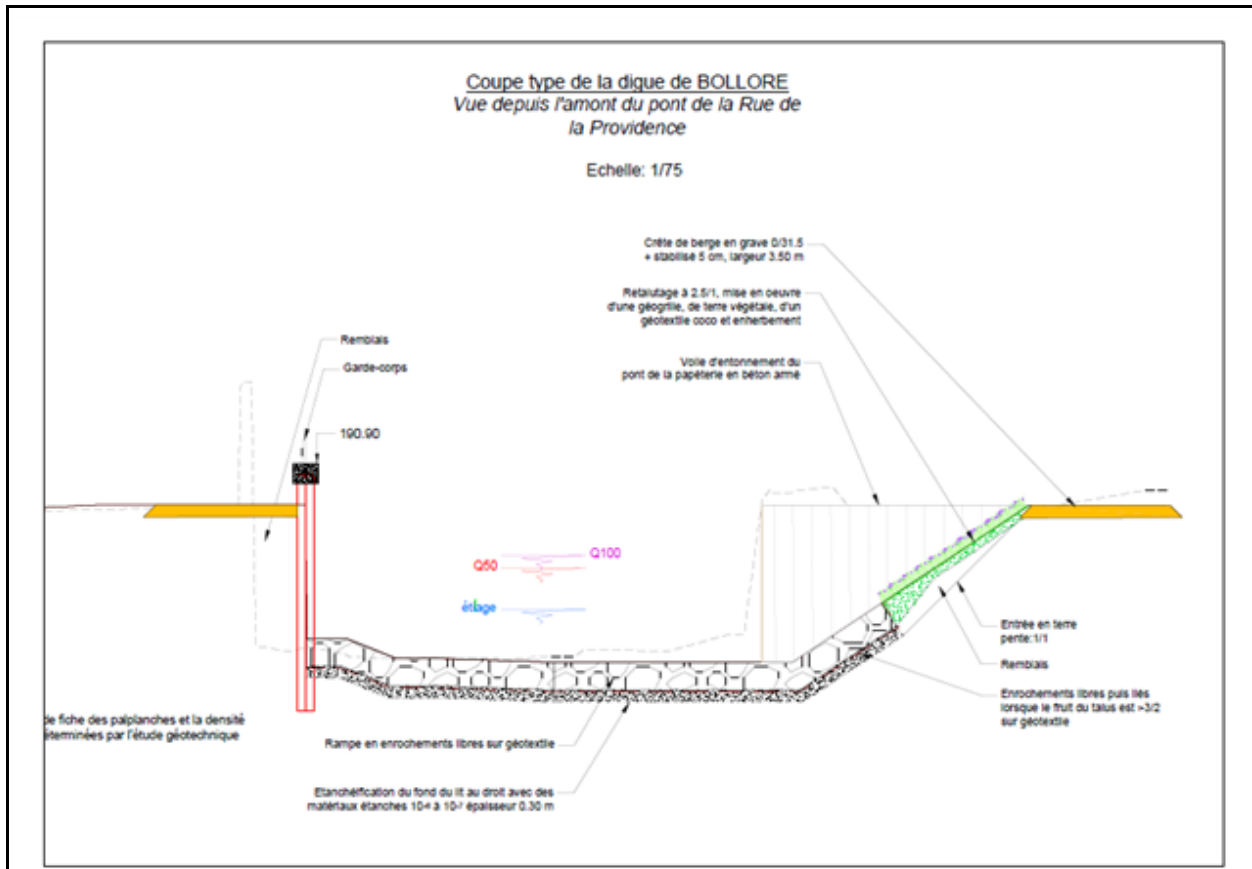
coupe digue du canal de la Papèterie au droit des entreprises
